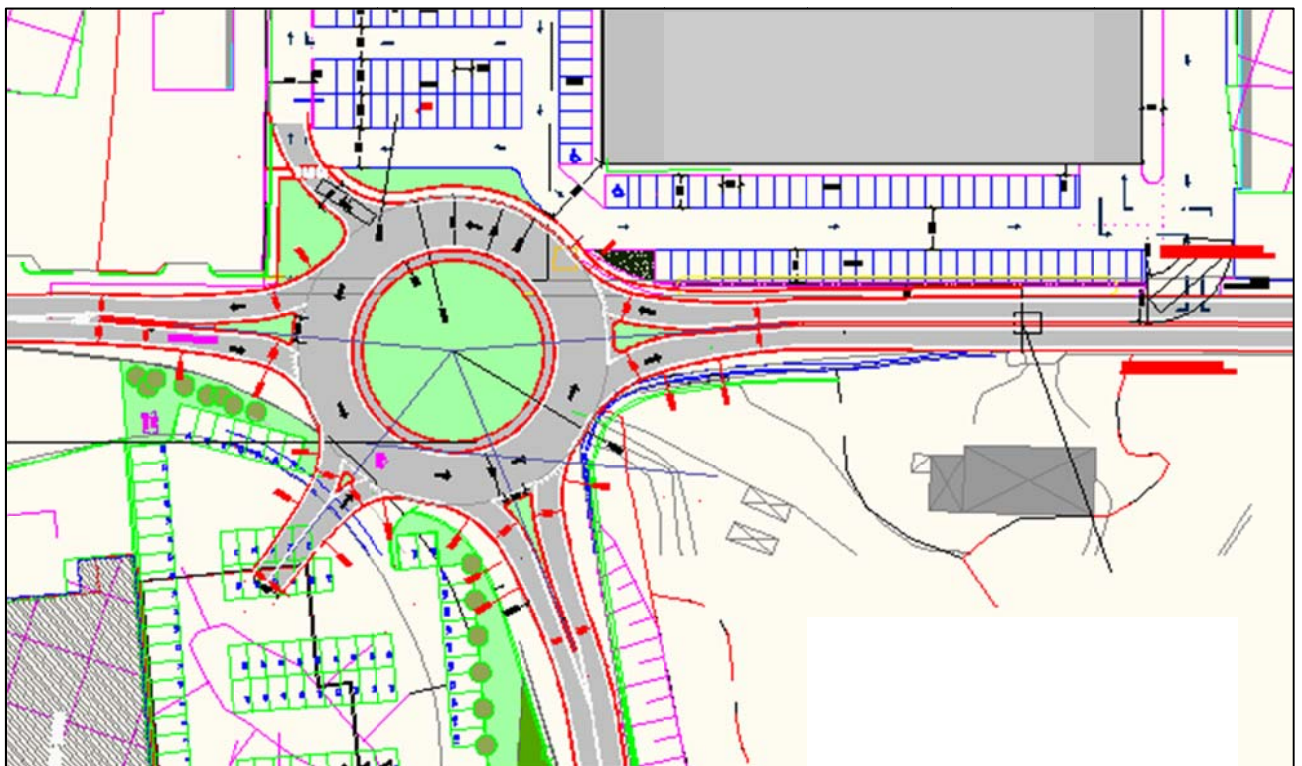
planimetria ipotesi progettuale originaria oggetto di modifica
